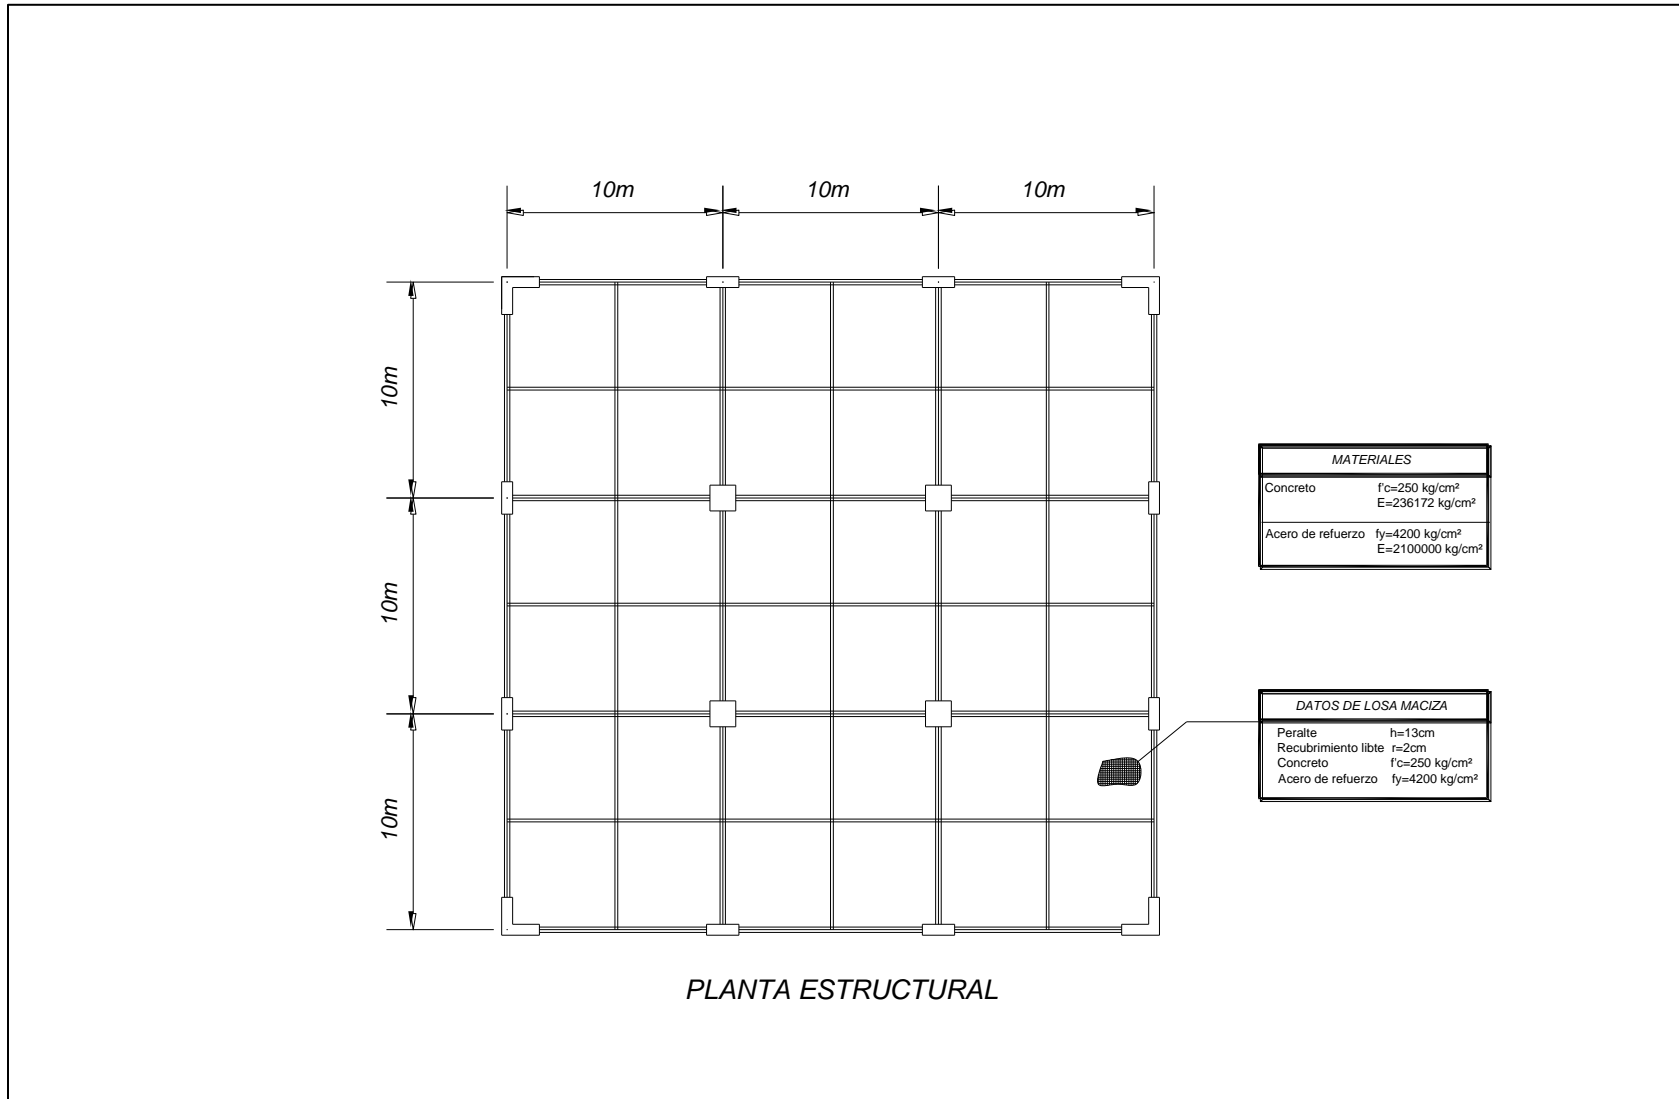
Detalles estructurales del edificio de 10 niveles diseñado con el ACI318-08
